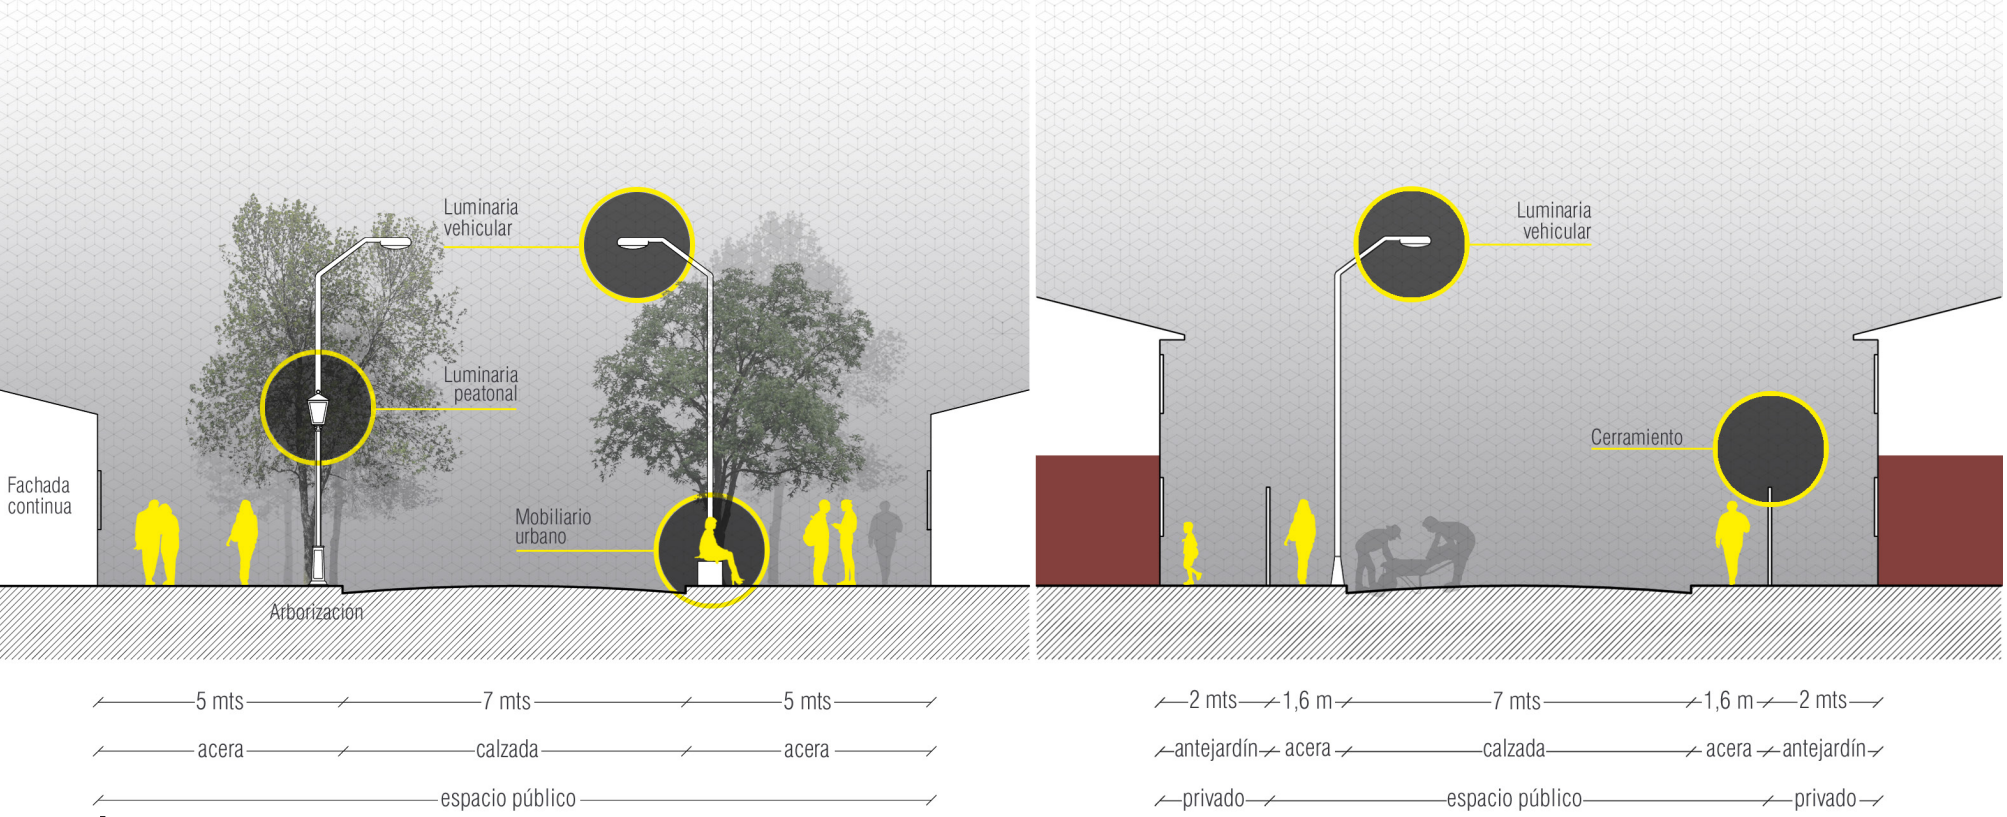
Vivienda tradicional fachada continua, Las Heras.
